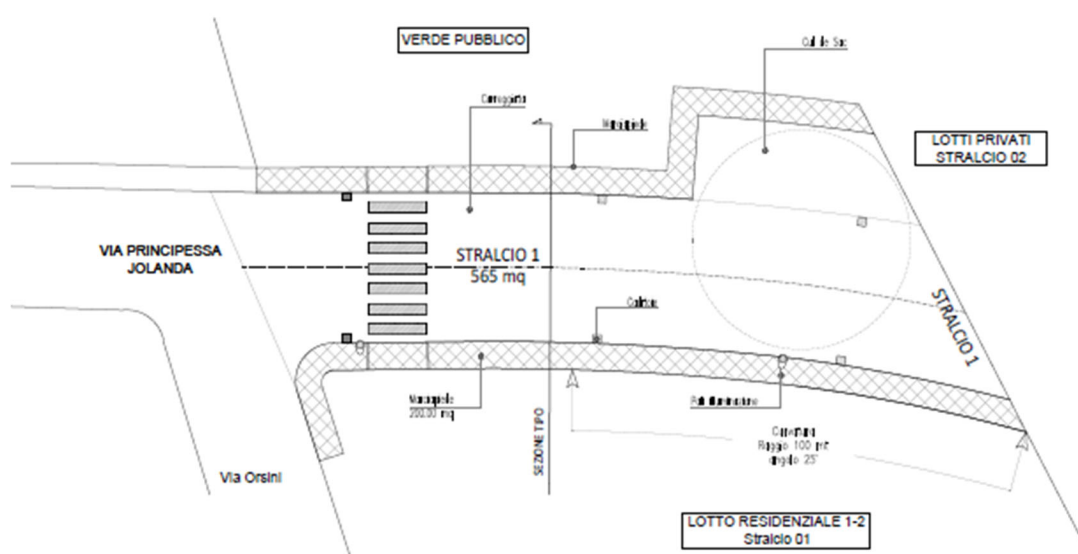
Planimetria sistemazione Via Principessa Jolanda
